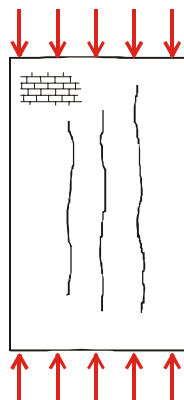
fissuras verticais induzidas por sobrecargas (DUARTE, 1998)
